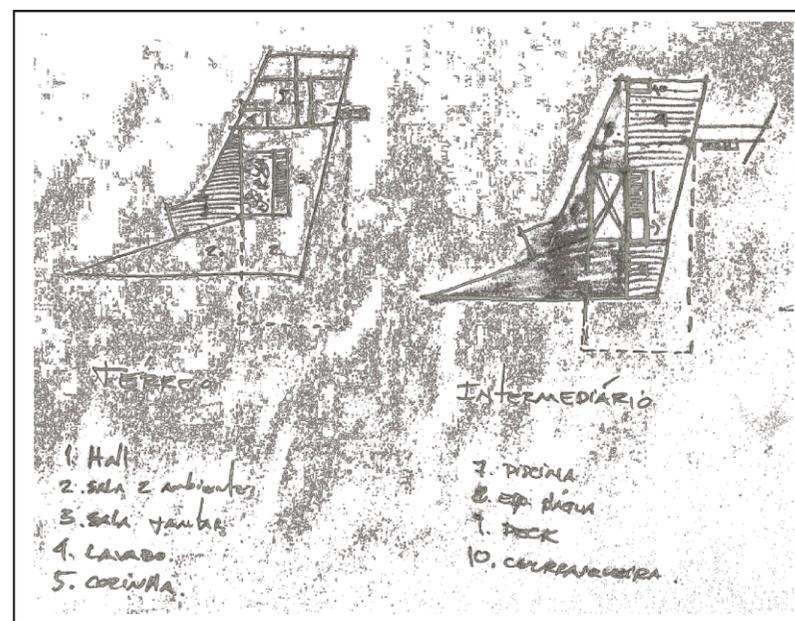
Plantas do pavimento térreo e intermediário realizadas pelo Arquiteto Novato 1.
